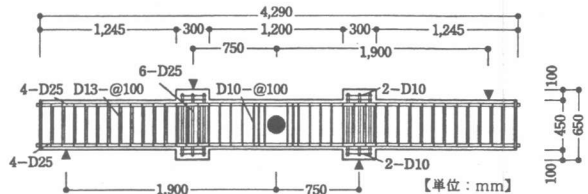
試験体の形状・寸法の例 (No. II-2試験体)
